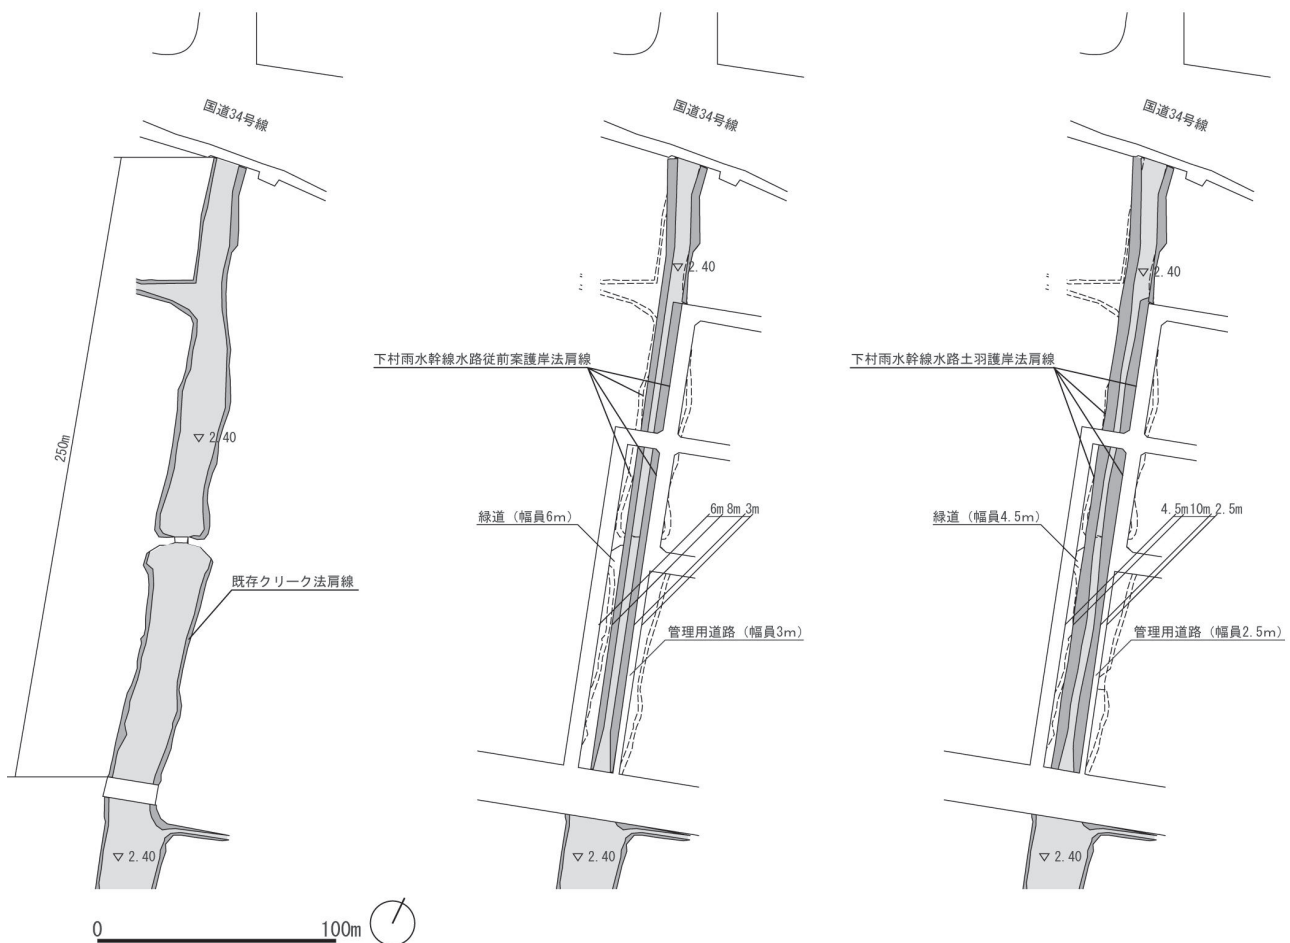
試験施工区間の平面図(左から「工事前の現況図」,「当初のコンクリートブロック護岸案」,「土羽護岸案」)
